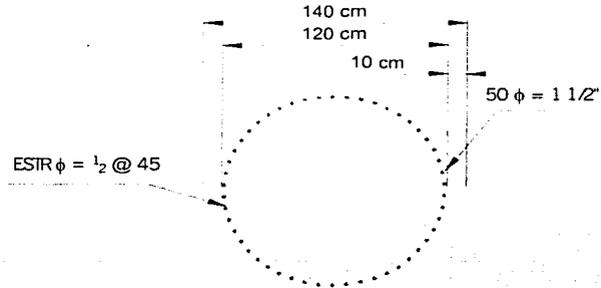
Croquis del Armado de Refuerzo en Pilas
